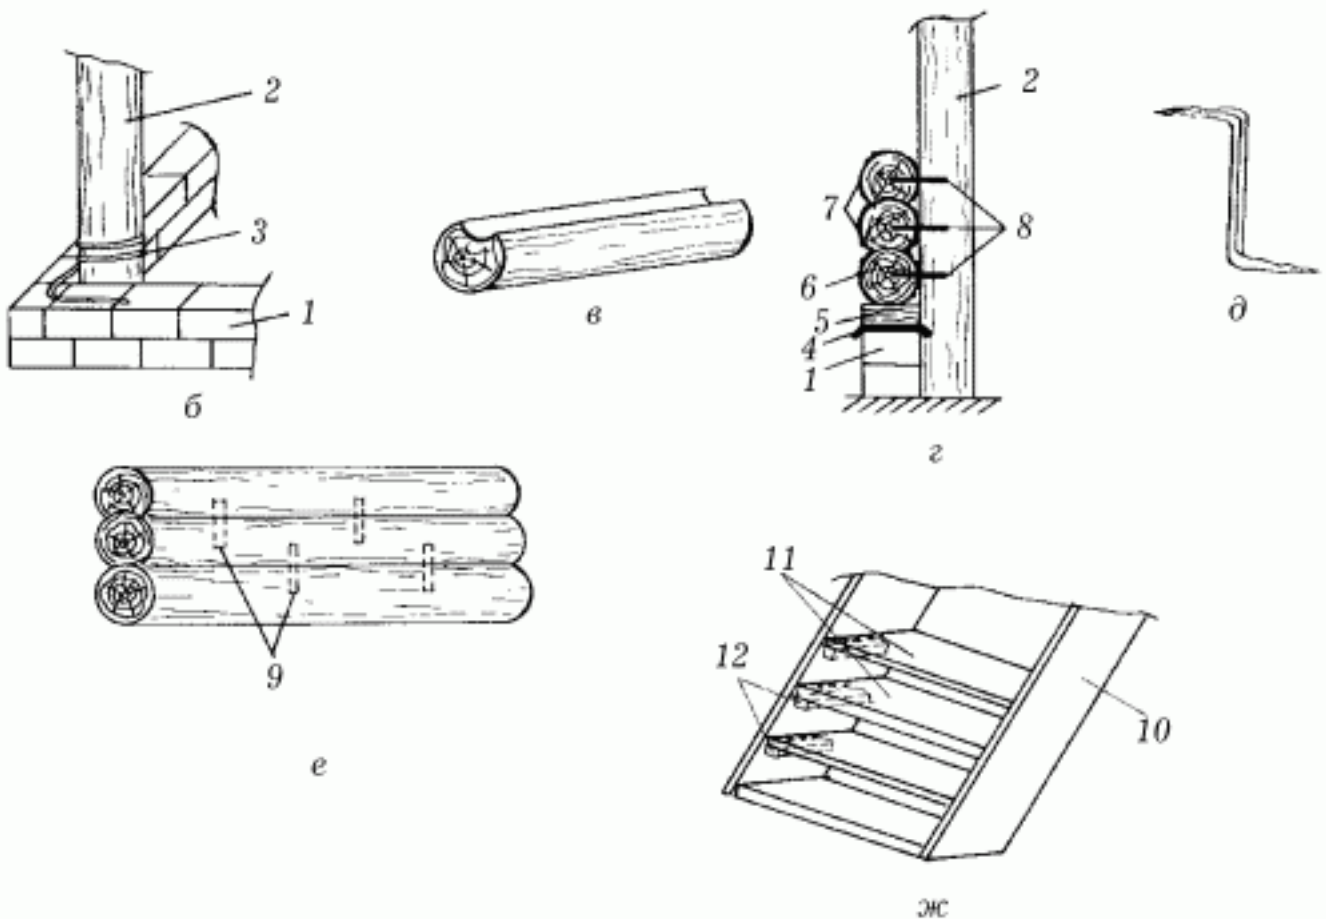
(продолжение). Беседка в русском стиле: б – крепление бревен-стоек к забирной стенке; в – вырубка паза; г – рубленая стенка в разрезе; д – скоба, повернутая на 90°; е – сплачивание венцов на
